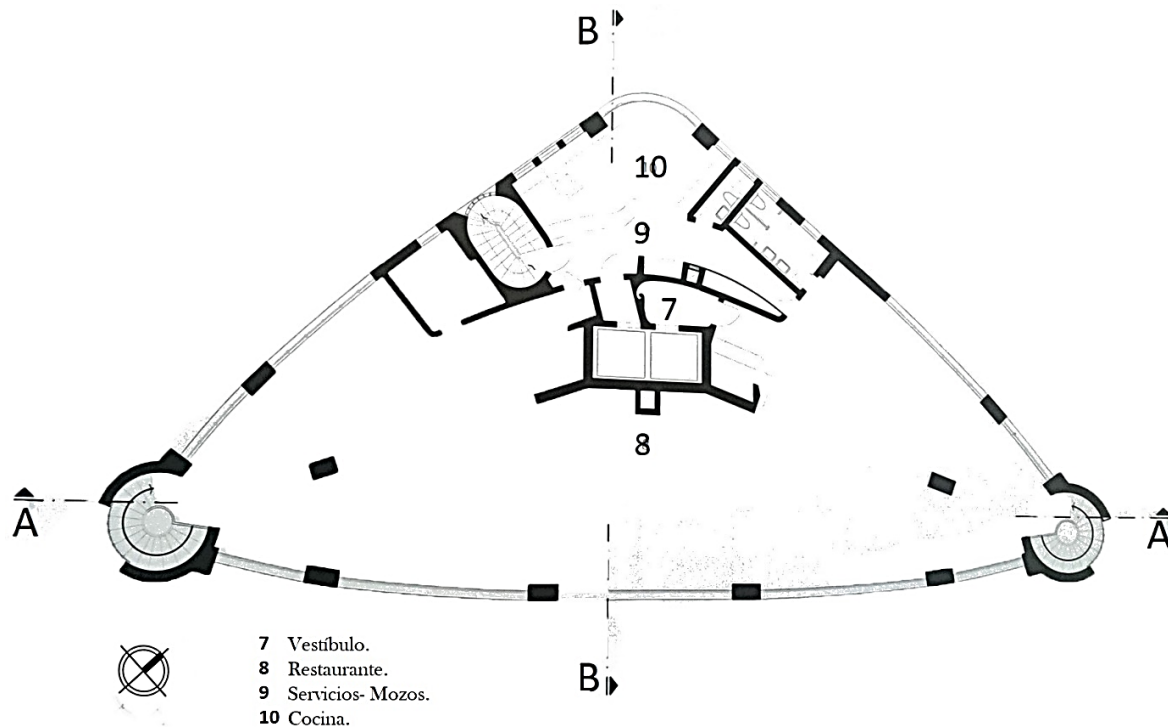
Planta del 2º nivel. Planta elaborada por Viccina (2015).
